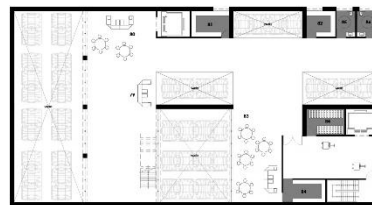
Planta de Distribución del Recinto - Primer Sótano
